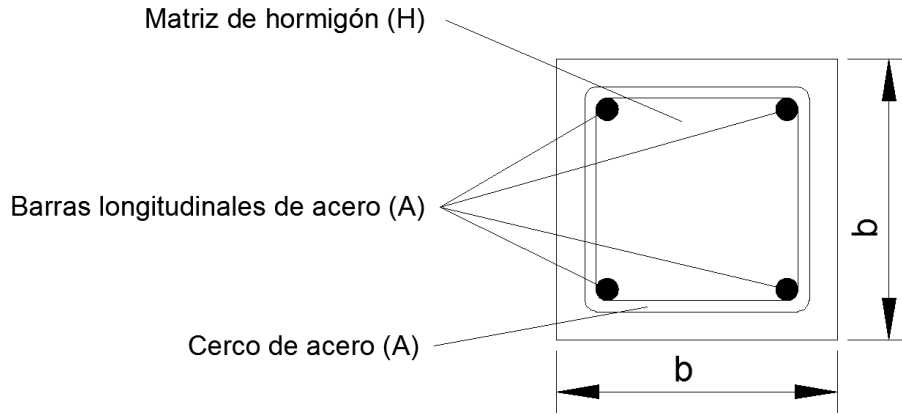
Esquema de la sección de la barra de hormigón armado con cercos
